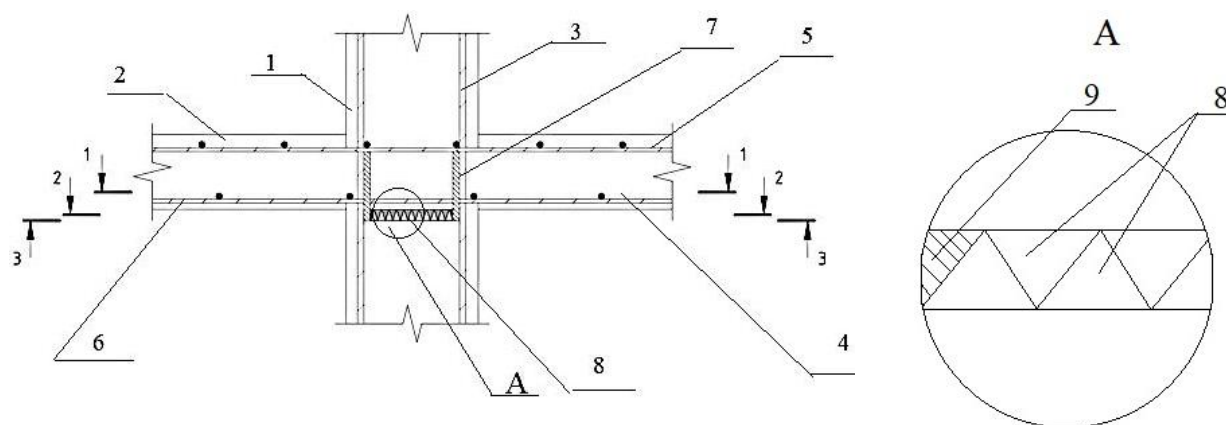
Соединение колонны с плитой перекрытия в разрезе: 1 – колонна; 2 – плита перекрытия; 3 – арматурный каркас колонны; 4 – арматурный каркас плиты перекрытия; 5 – верхняя сетка; 6 – нижняя сетка; 7 – металлические вставки; 8 – гасители колебаний; 9 – эластичный материал; А – гасители колебаний в разрезе
